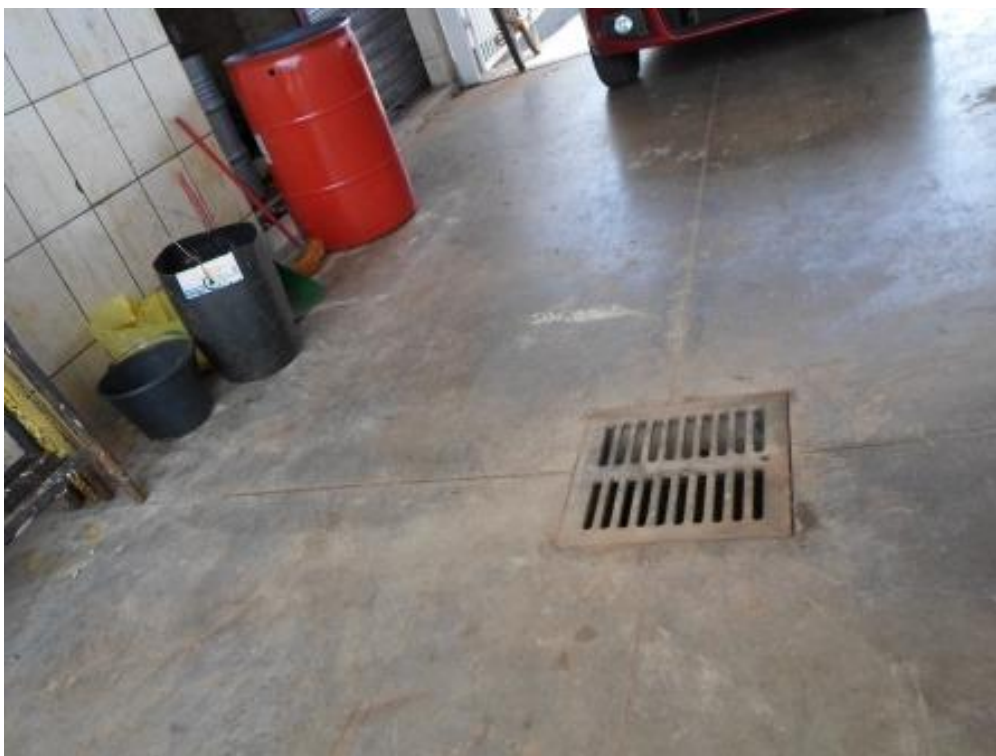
Caixa de areia central da pista de lavagem de veículos. Esta área está desativada.
